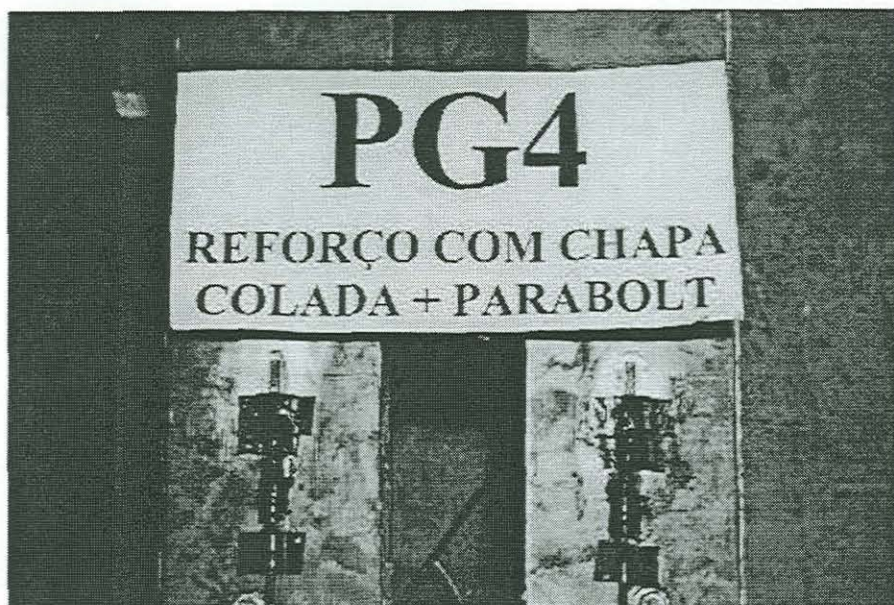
Instrumentação das chapas de aço, na seção central, com extensômetros elétricos.
